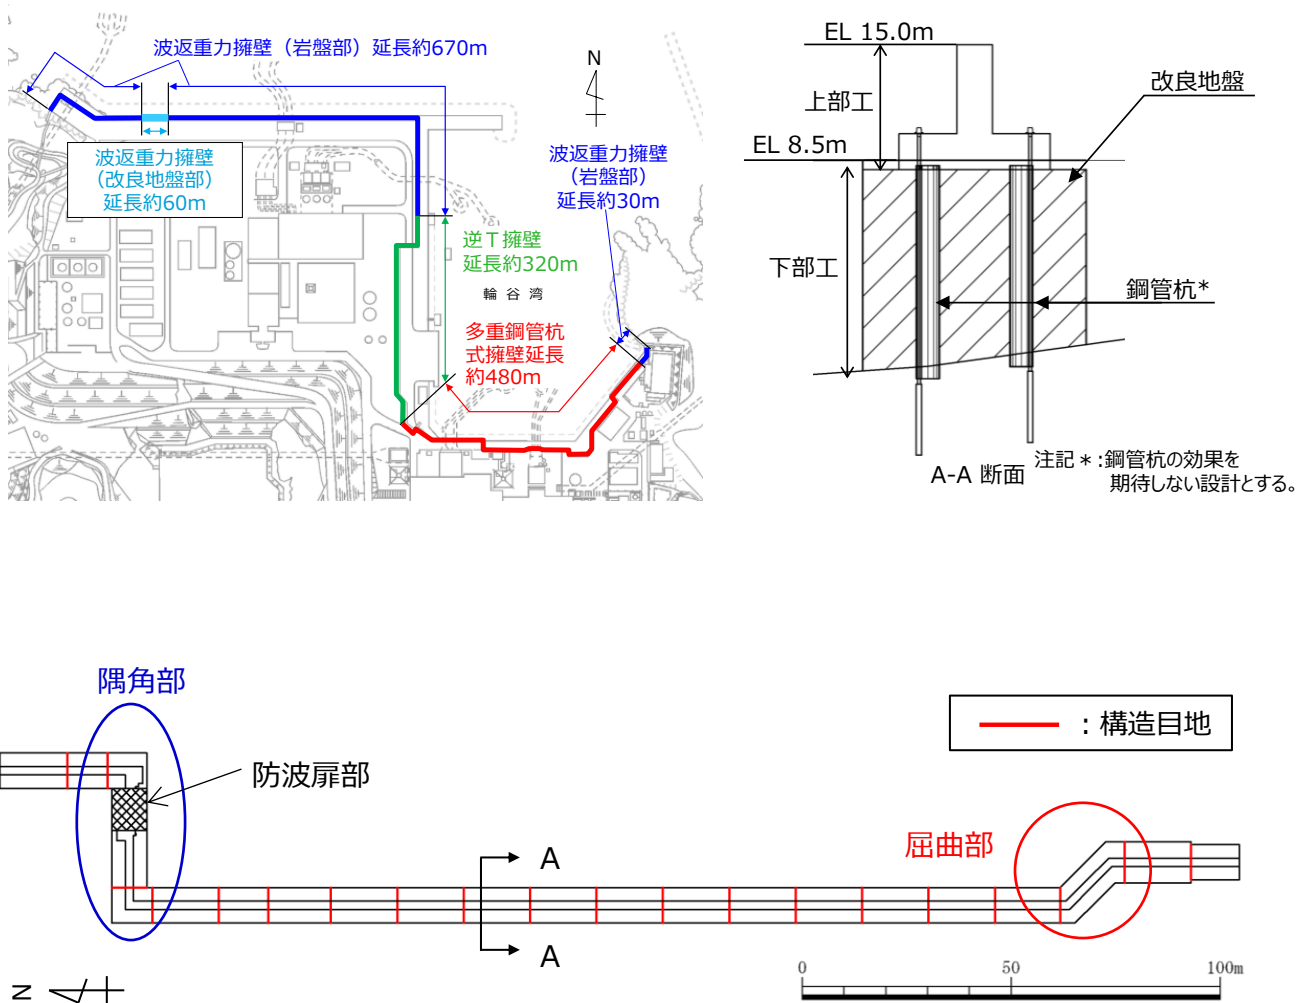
防波壁（逆T擁壁）の構造目地（平面図）
